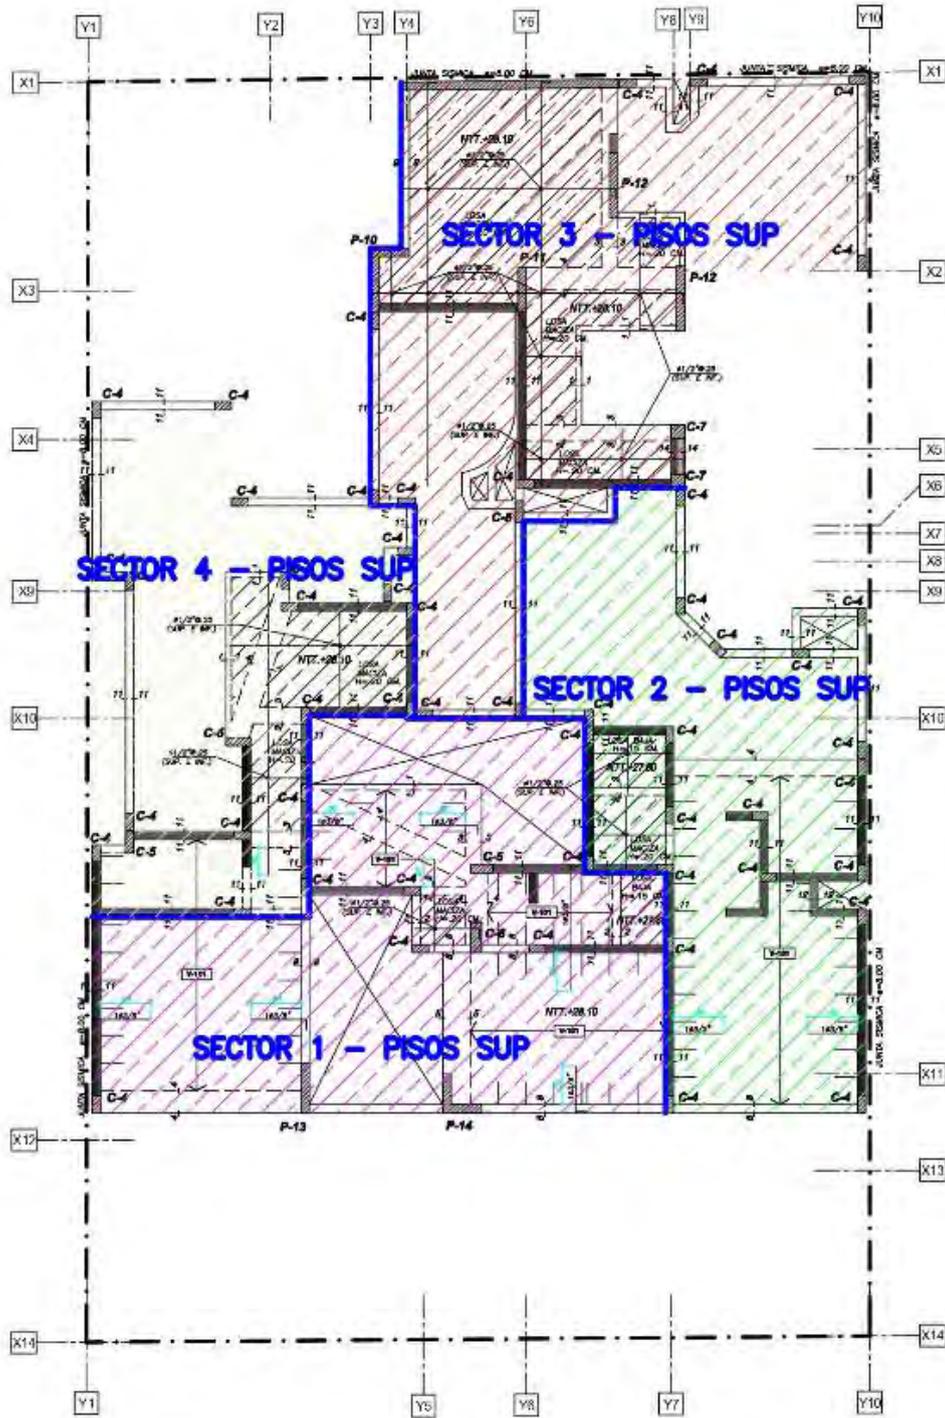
Sectorización desde el encofrado de la azotea para la construcción del proyecto.
